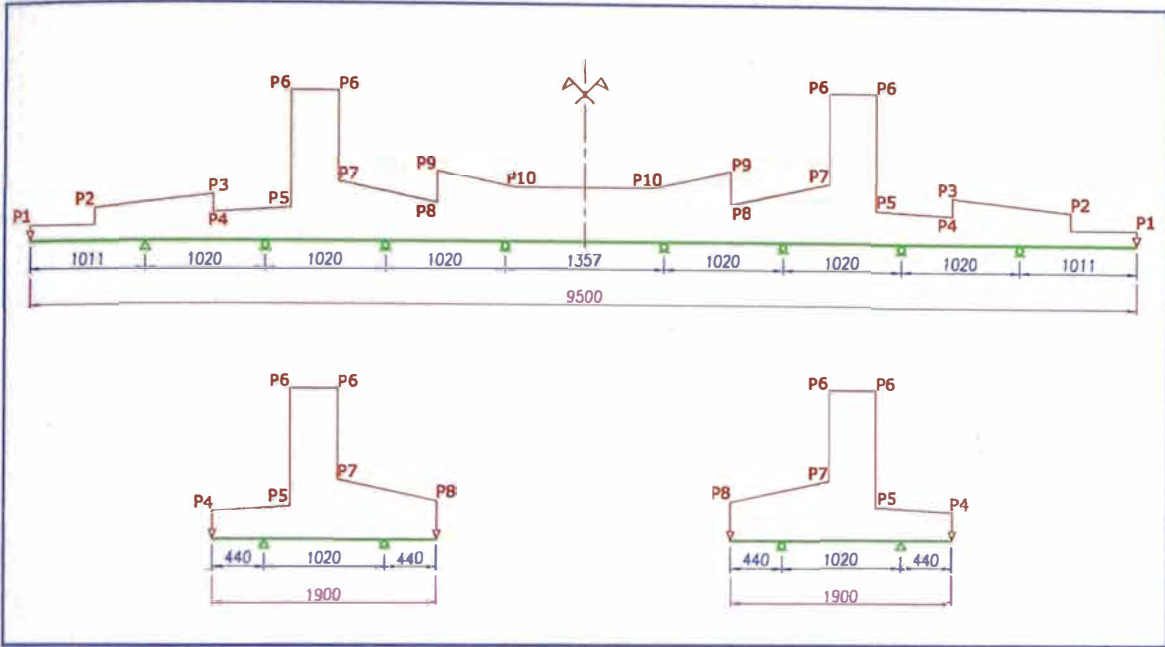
Esquema de cálculo - Vigas Ulmaflex - Fondo de Losa
